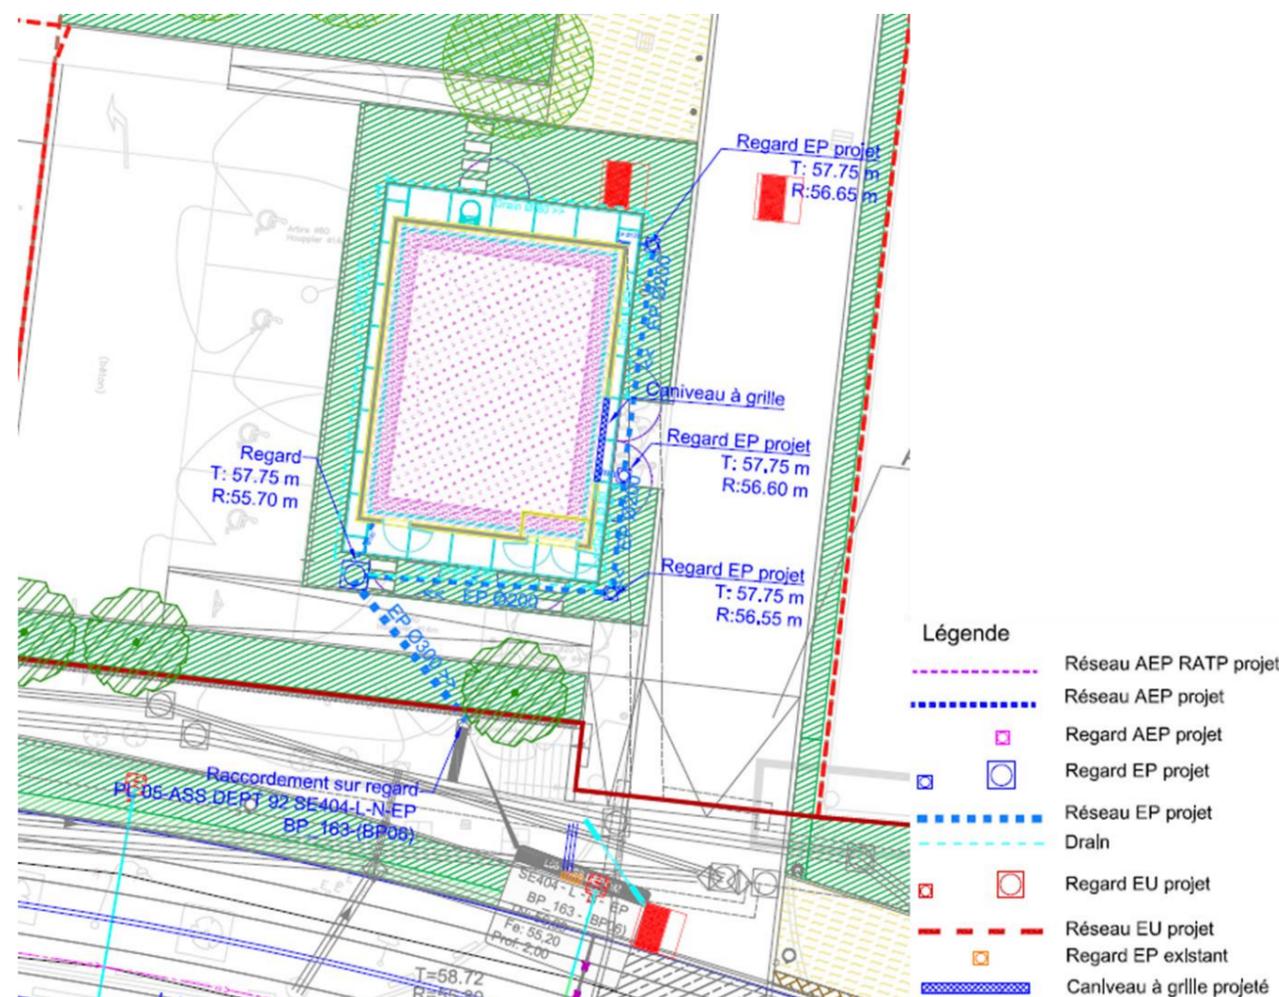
Réseau d'assainissement des eaux pluviales de toiture : exemple site Parc, source : Groupement SARA
